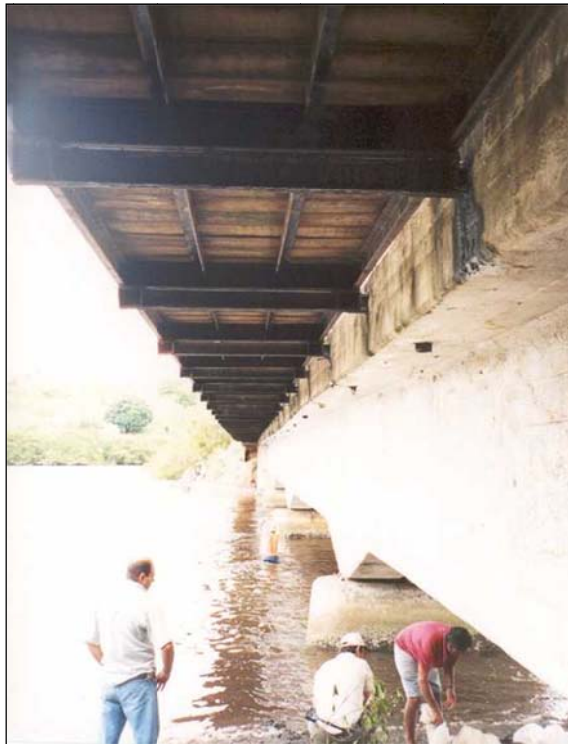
Vista superior, lateral NO. Notar exposição da laje e furo de drenagem (buzinote).
